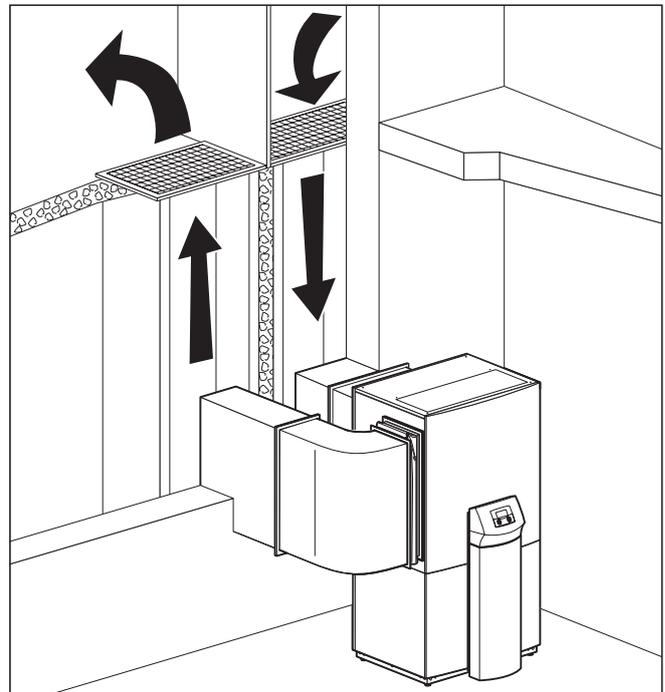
Deux conduits d'air (représentés ici sans rails porteurs) sur la même surface murale
